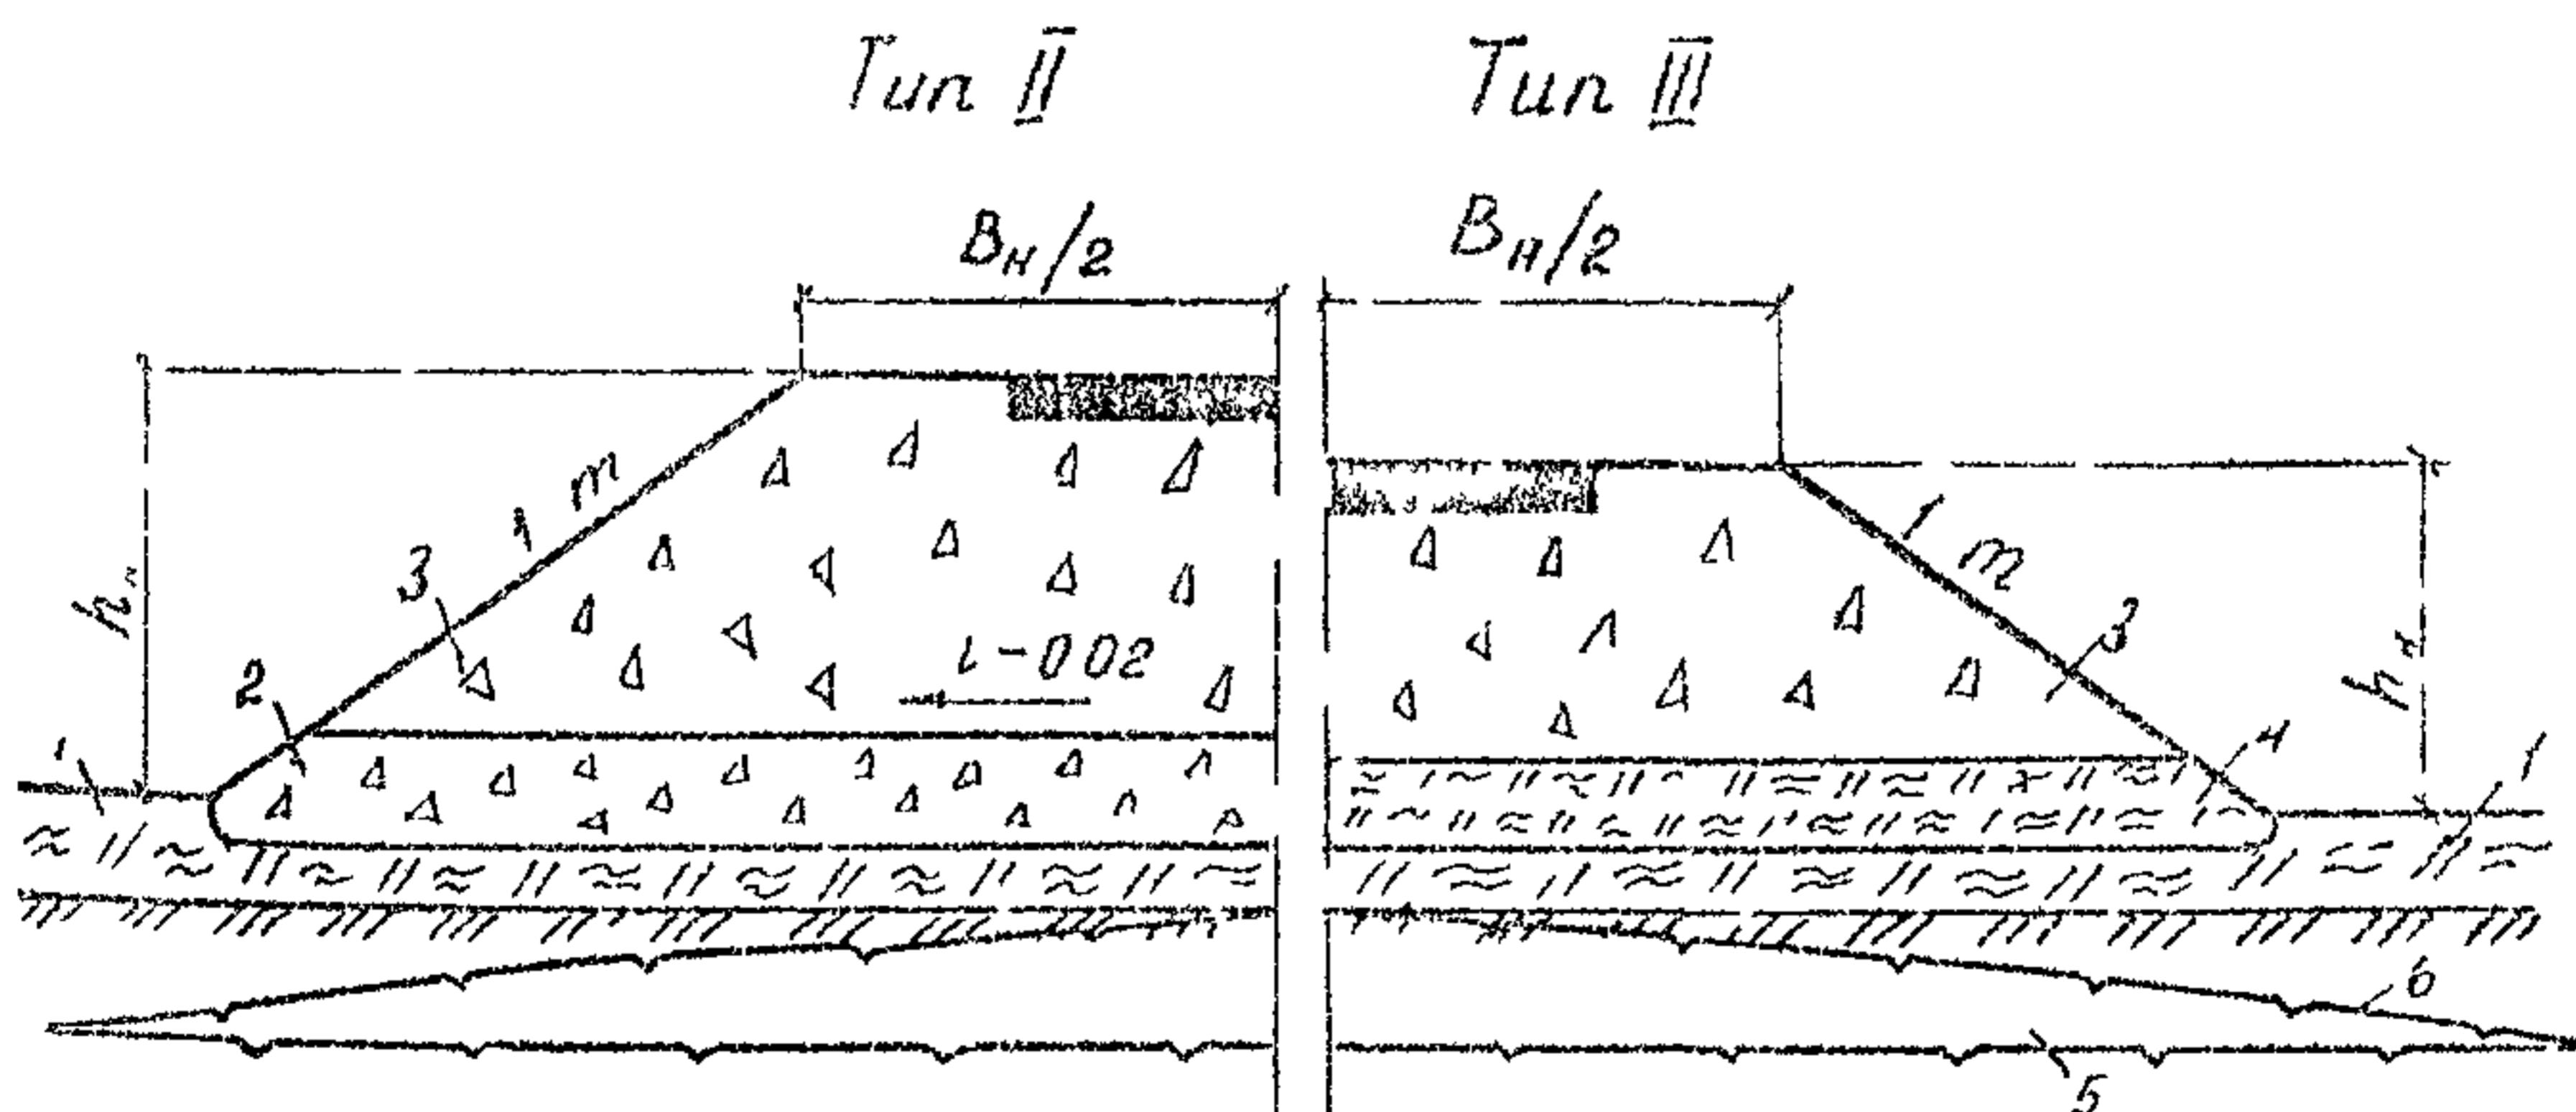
Поперечные профили насыпи на льдонасыщенных грунтах: 1 - мохорастительный покров; 2 - защитный слой из преннирующего грунта мелких фракций; 3 - несцементированный обломочный грунт; 4 - термоизоляция из ила (чертежаются на основе теплоизационного расчета); 5 - ВГМ до постройки насыпи; 6 - ВГМ после постройки насыпи
